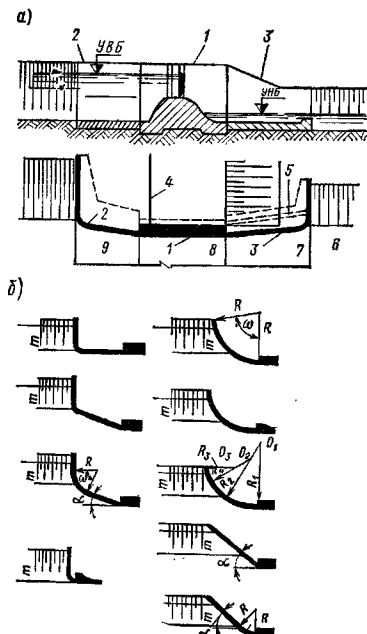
Схема сопрягающего устоя (а) и очертания верхних стенок (б)
